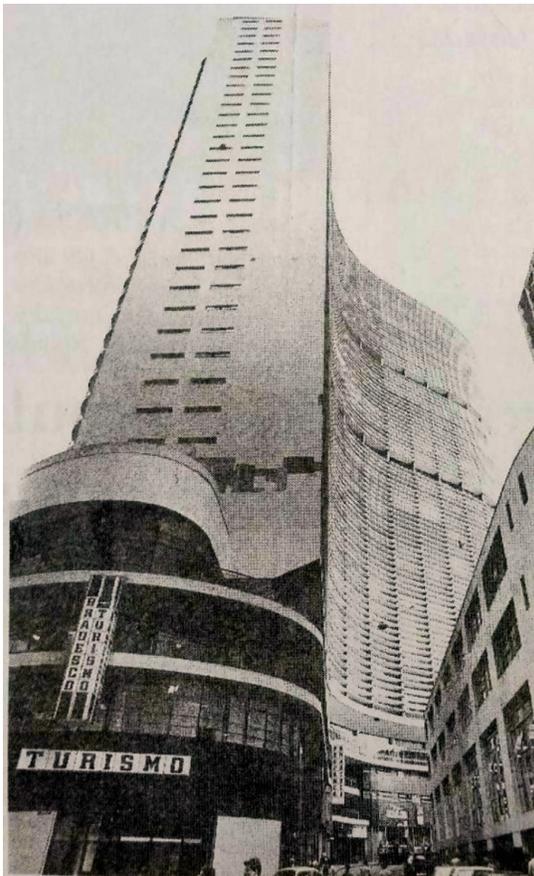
Degradação da fachada publicada em 1991 pelo jornal *Folha de S.Paulo
